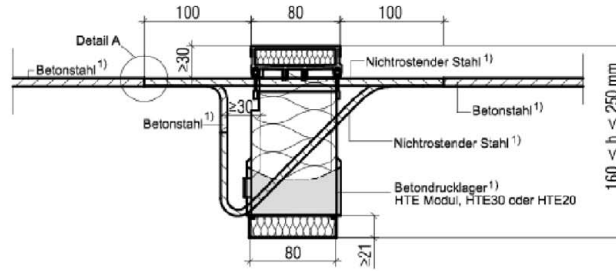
Schöck Isokorb® T Typ K-ID mit Betondrucklager mit integrierter Aufhängebewehrung
